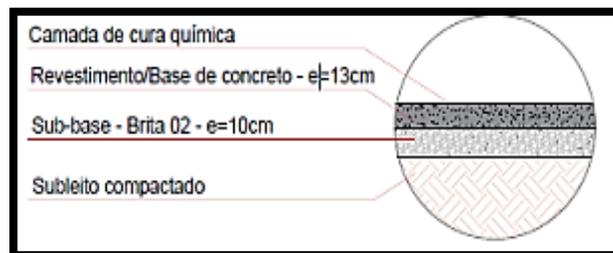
Estrutura do pavimento rígido. Fonte: Maschio, 2022¹².
